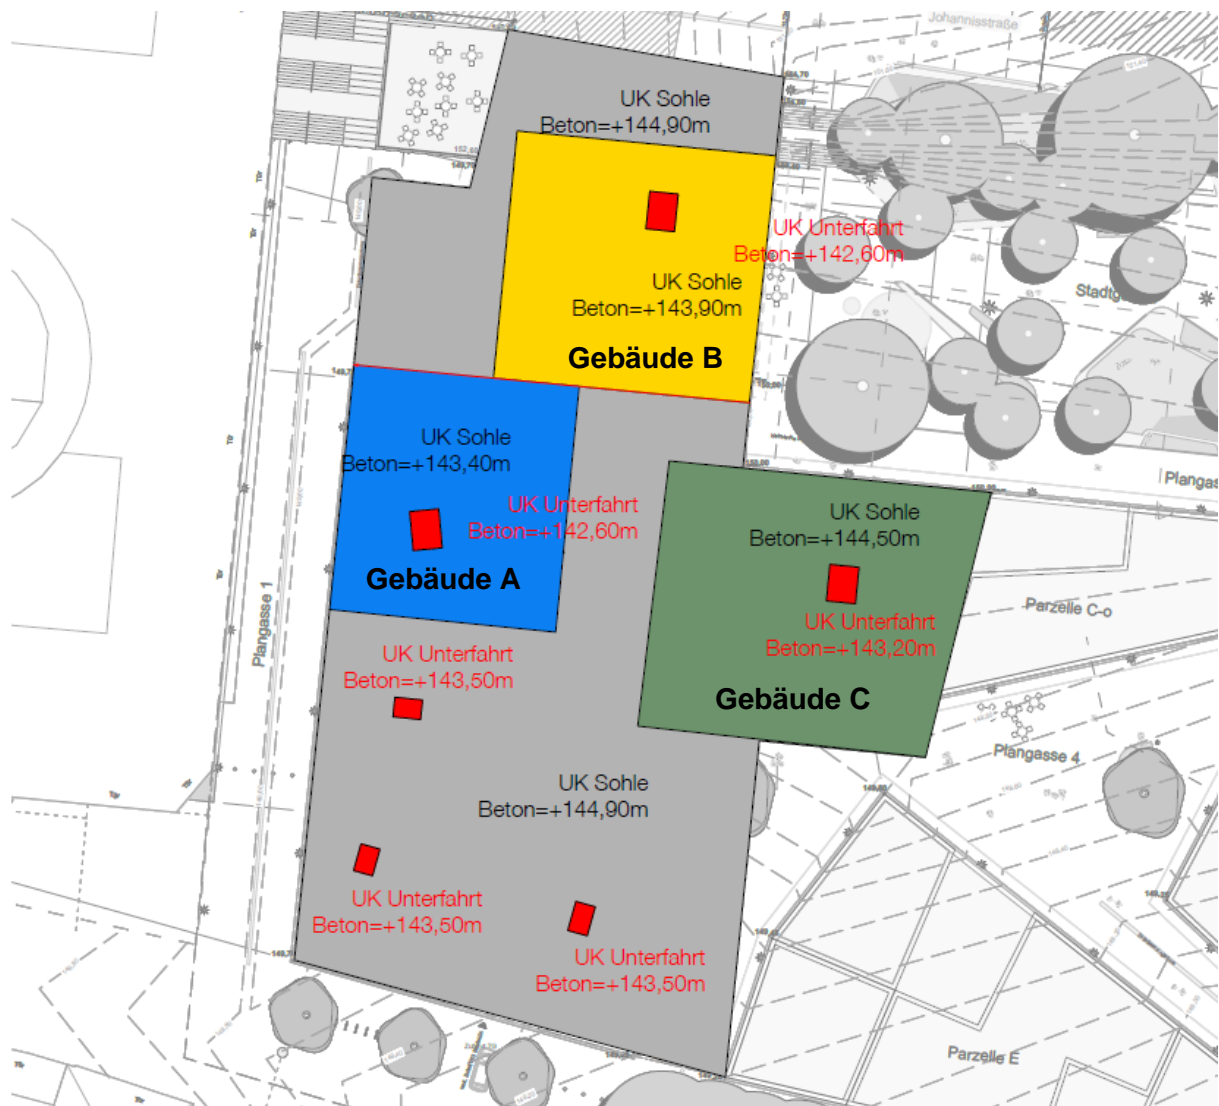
Planung Baugrubensohle; Planungsstand 16.04.2021
